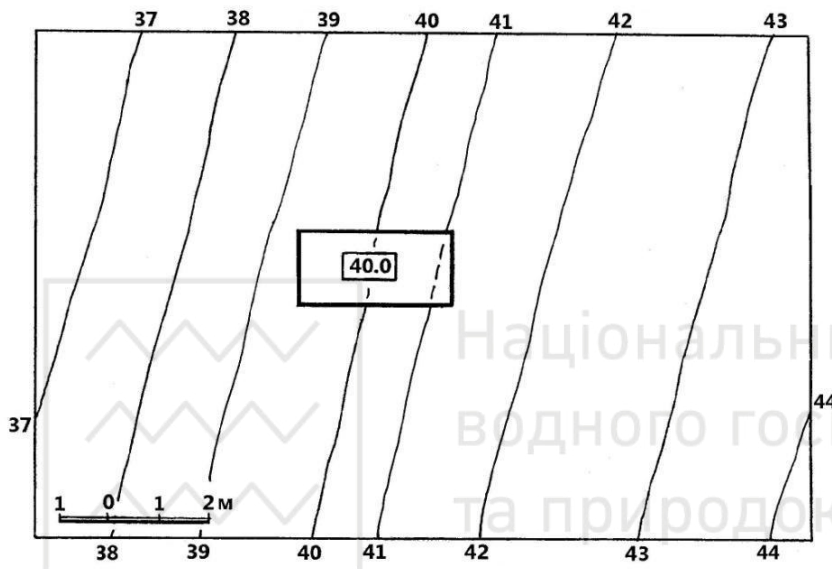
До побудови меж земляних робіт укосів будівельного майданчика
